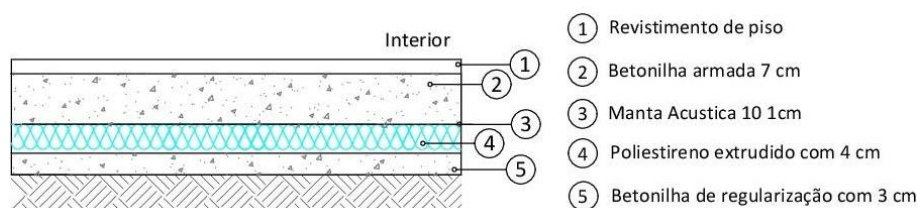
Pormenor de pavimento em contacto com o solo
